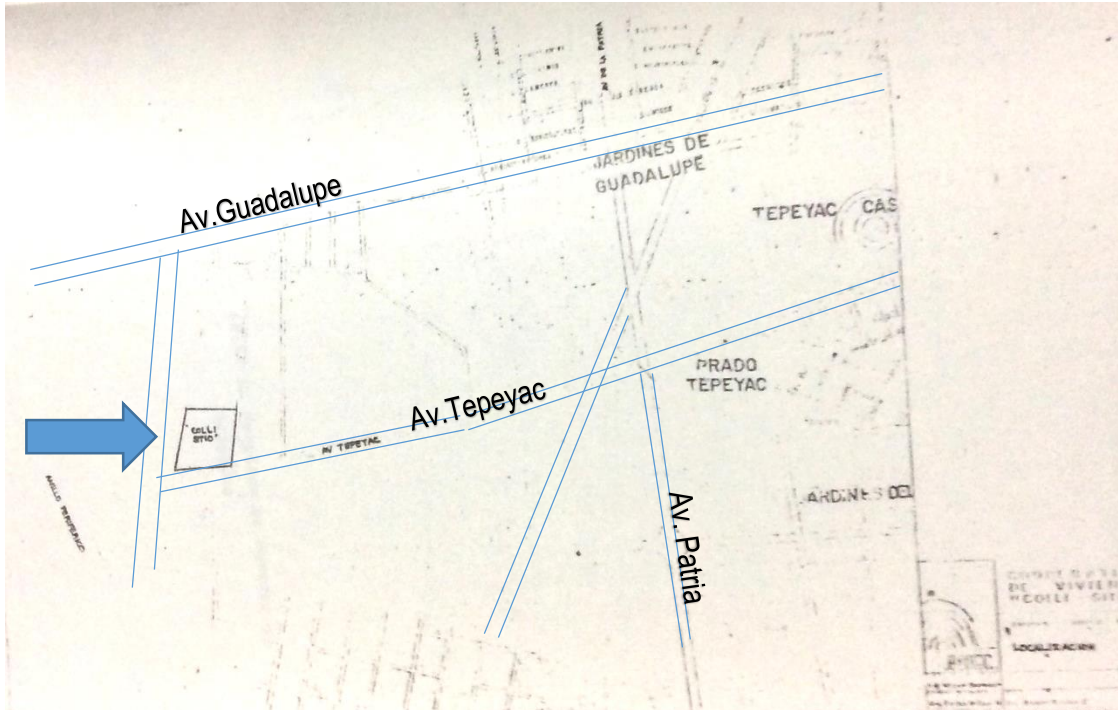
Planos de ubicación del predio "Colli Sitio", Trazo propio sobre extracto de Ibáñez, 1979.
